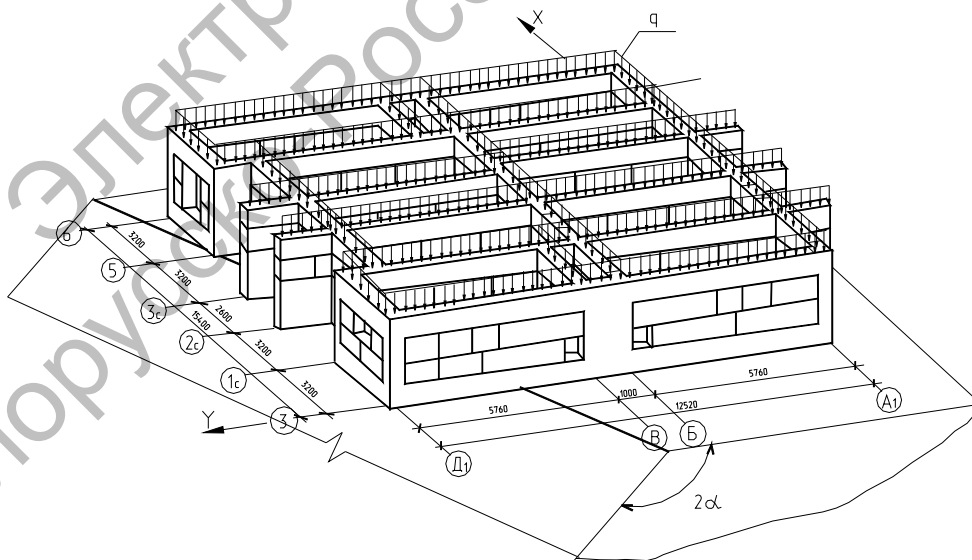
Пространственный железобетонный фундамент в виде системы перекрестных балок на упругом клиновидном основании
